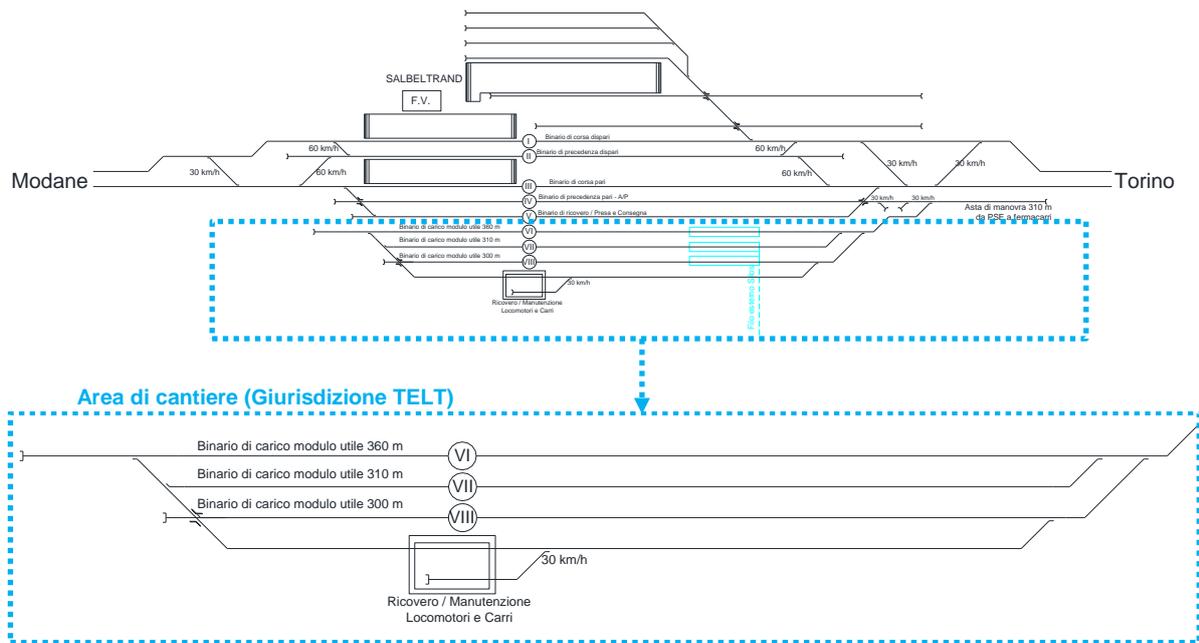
Layout della zona di carico/scarico nel cantiere di Salbertrand
